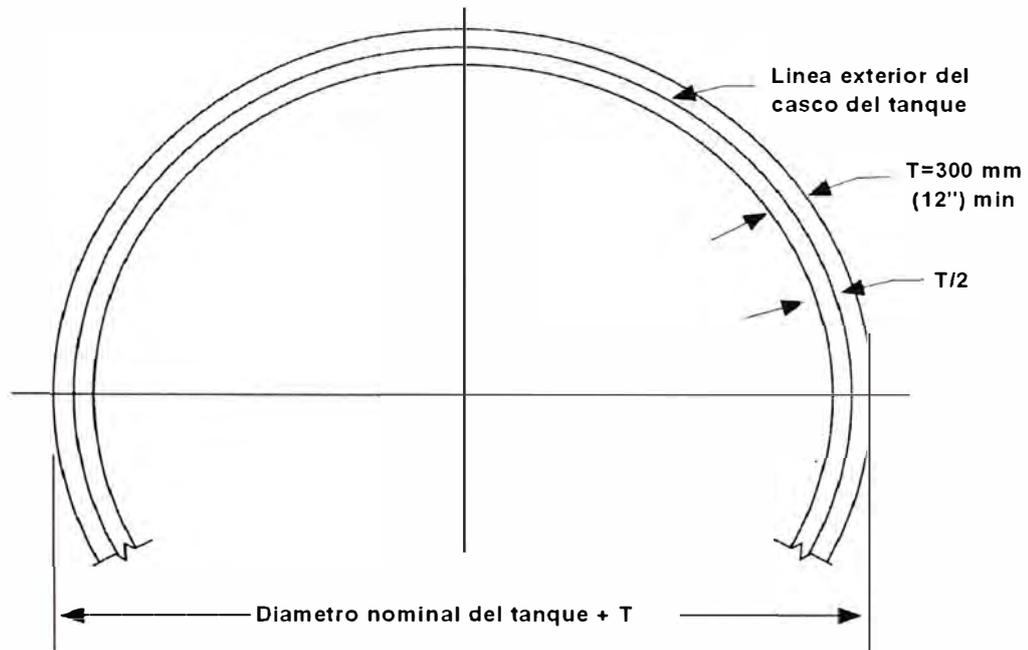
Vista de planta del anillo de concreto en la base de un tanque
